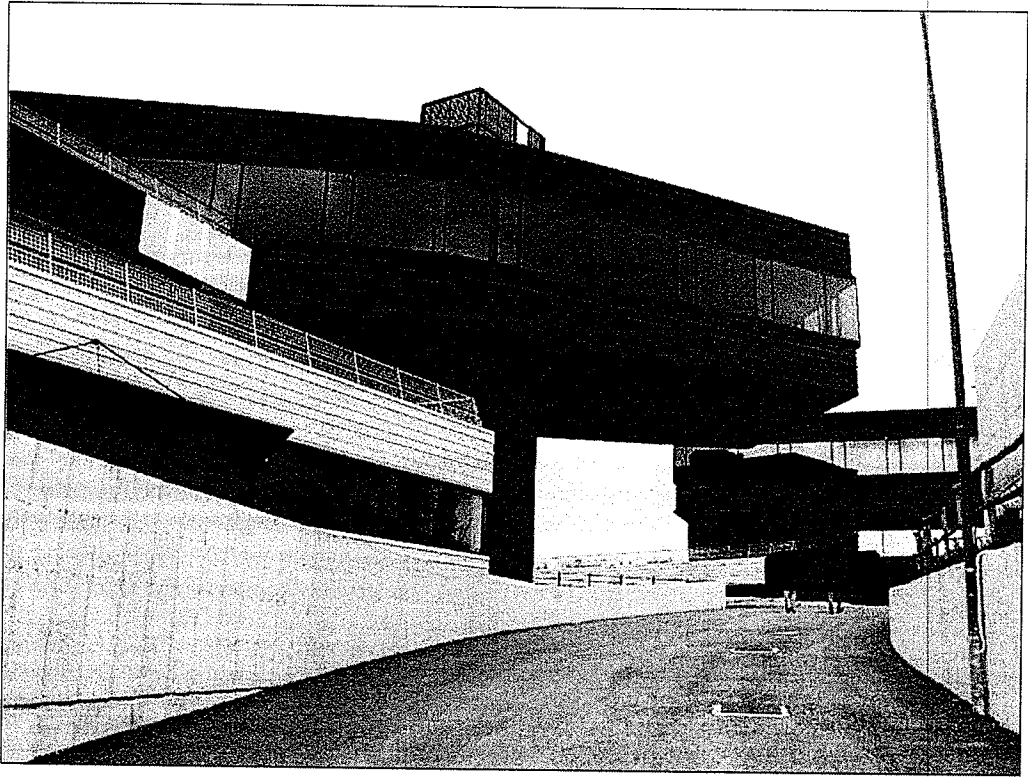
Strada di accesso al piazzale est secondo piano sottostrada
